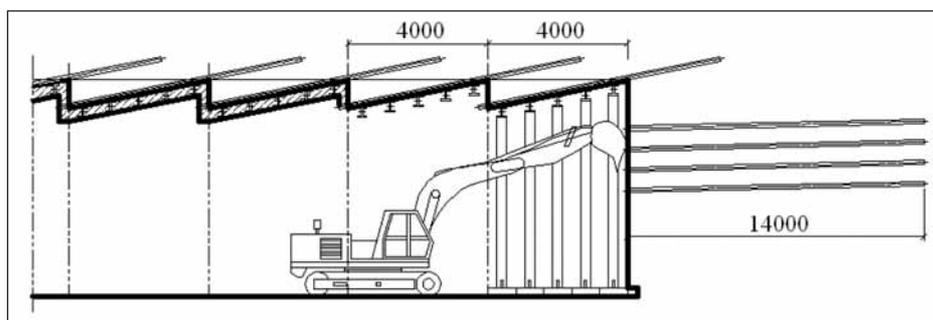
Армирование инъекционными фиброглассовыми анкерами грунтового массива и экрана из труб впереди забоя тоннеля
